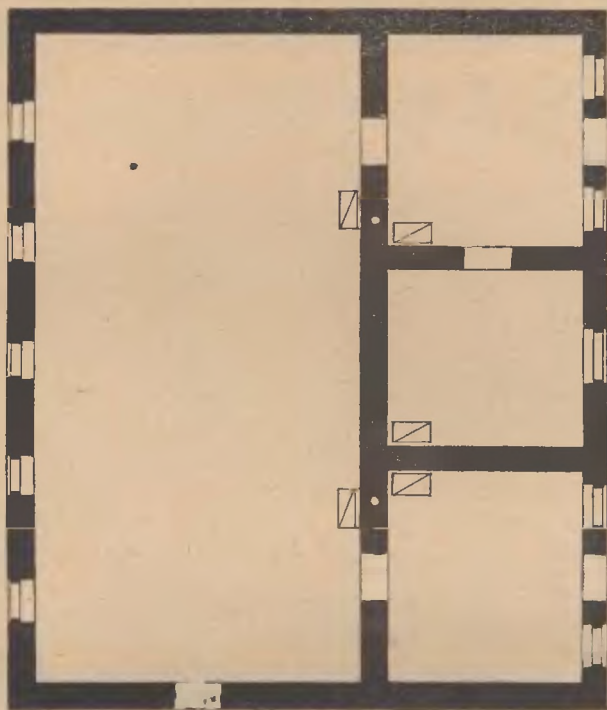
Rzut poziomy sali gimnastycznej. (Grundriss der Turnhalle.)
